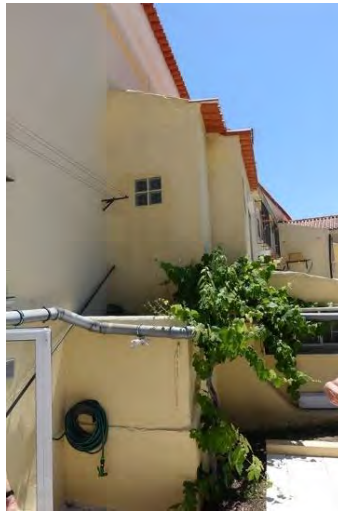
Construções adossadas a noroeste cuja demolição está prevista.
